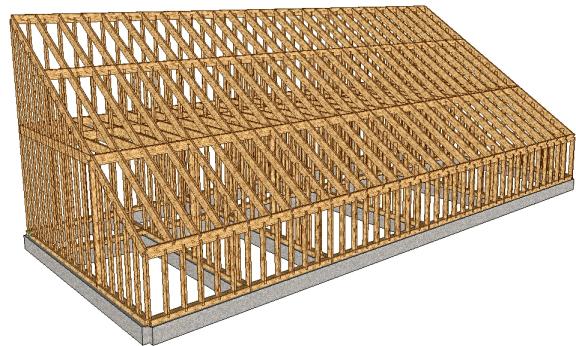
Structură pe cadre ușoare realizată din montanți, rgle și căpriori/Wood light framing strength structure made of studs, joists and rafters
